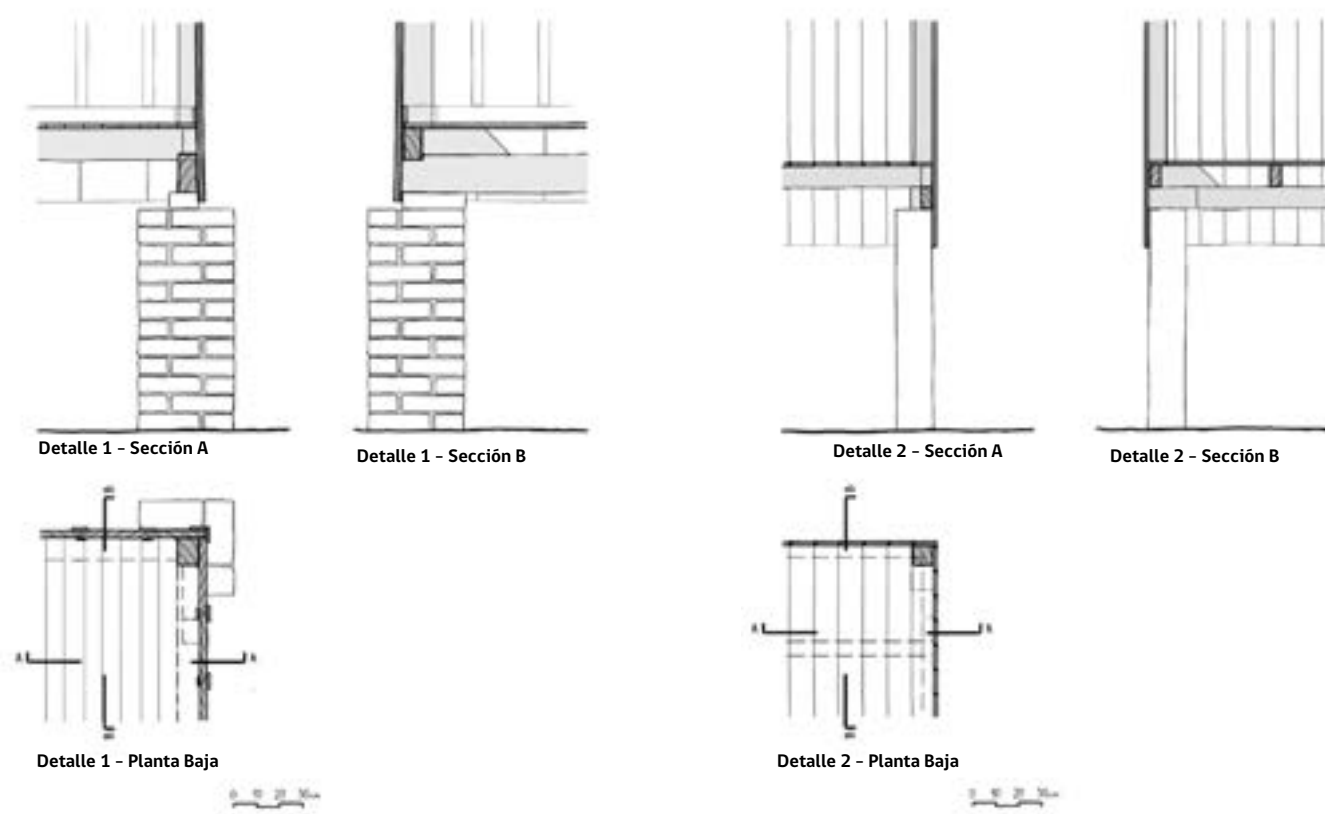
Detalles constructivos 1 y 2. Fuente: Elaboración propia.
